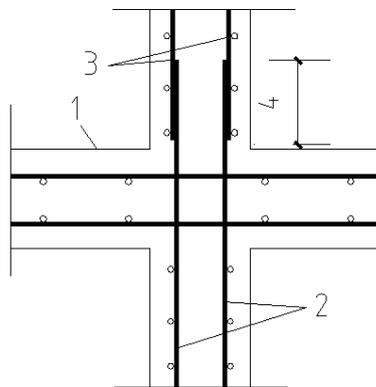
墙体钢筋焊接网的竖向搭接
